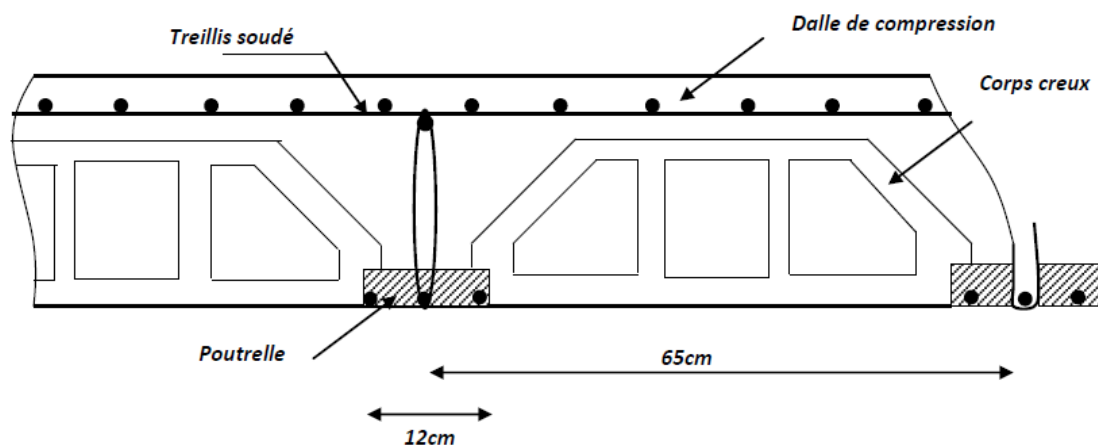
Coupe transversale d'un plancher à corps creux
